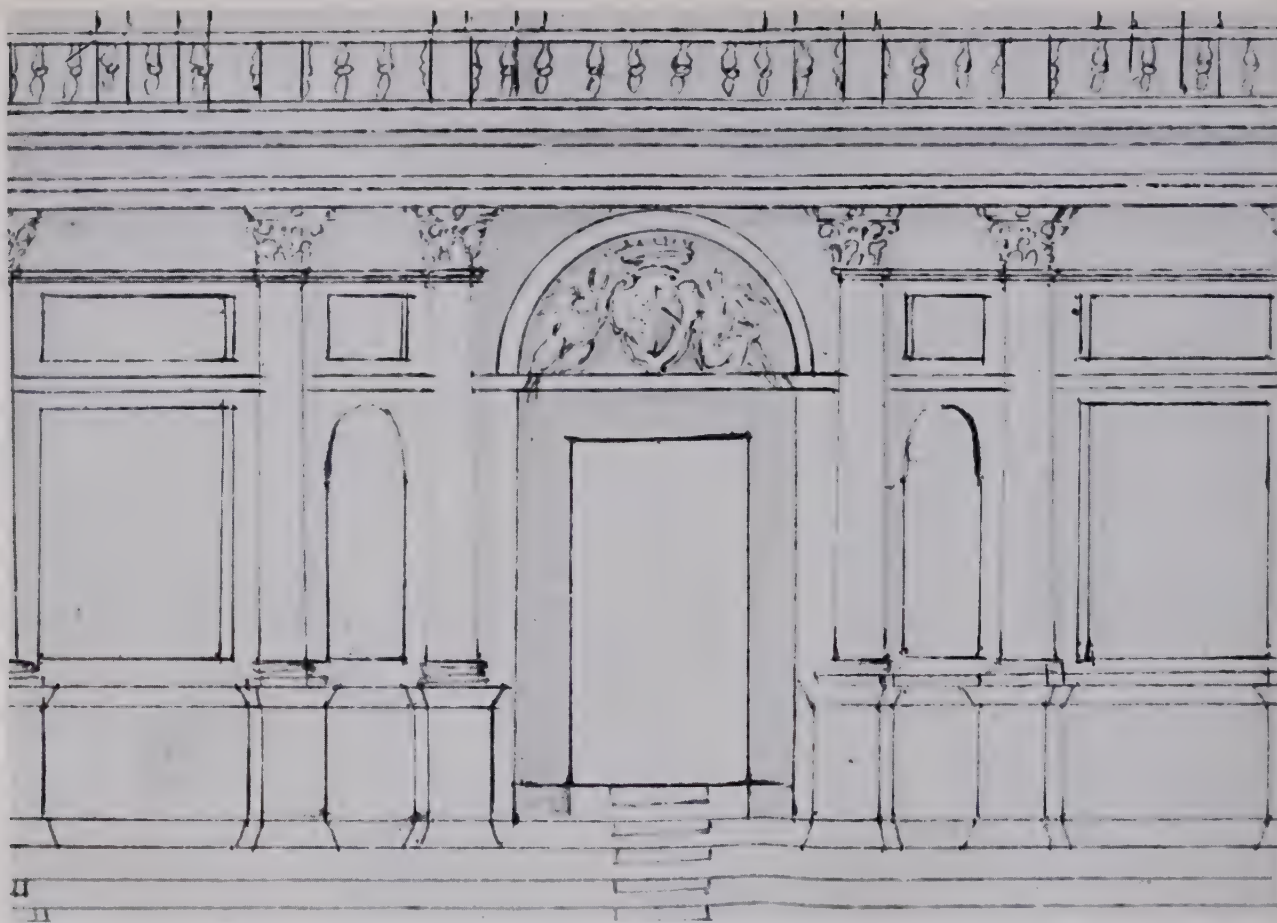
Dettaglio centrale dell'illustrazione precedente
